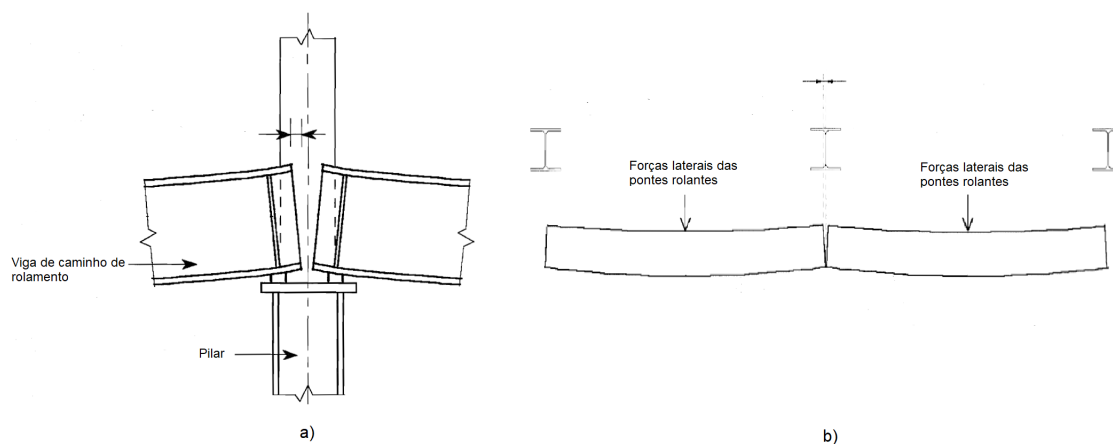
a) Rotação devida a forças verticais na extremidade da viga (vista em alçado), b) Rotação devida a forças horizontais na extremidade da viga (vista em planta), adaptado de [36].
